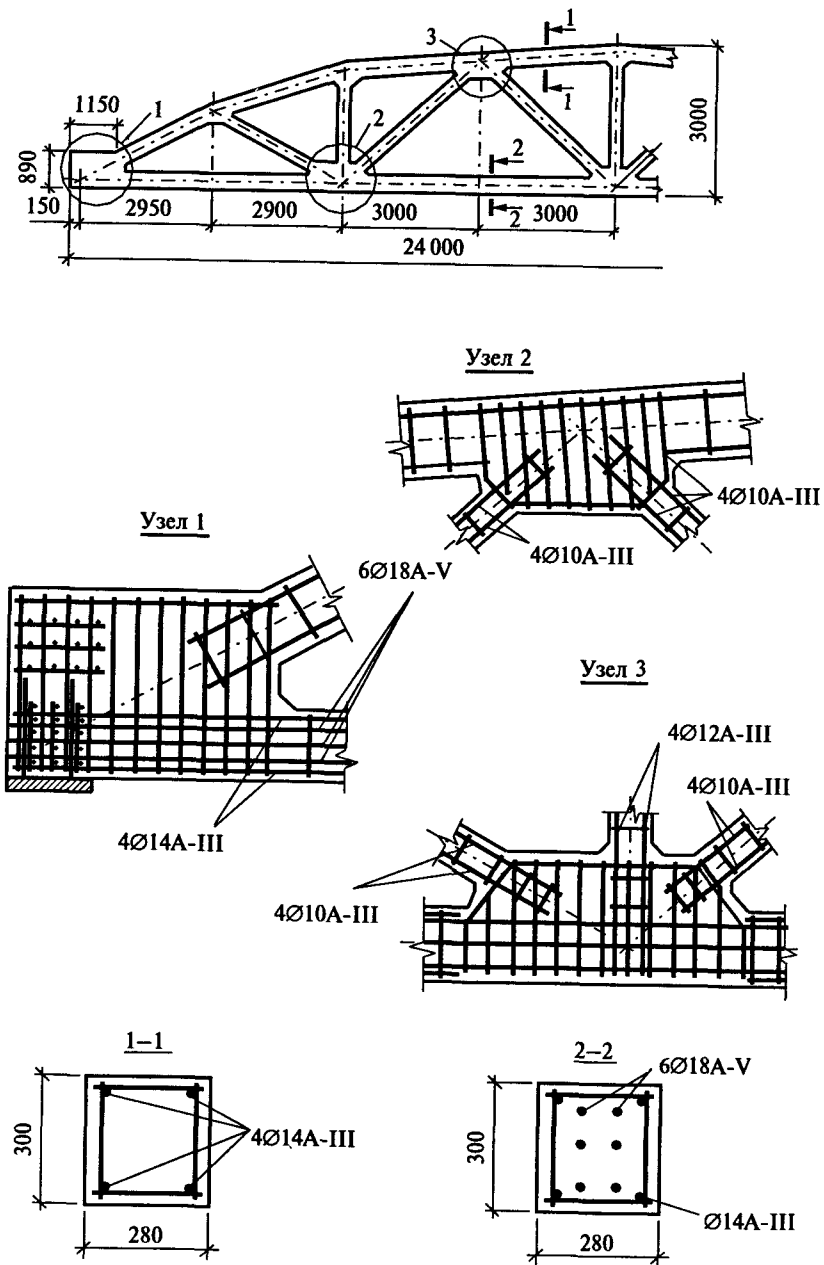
Железобетонная сегментная ферма пролетом 24 м
